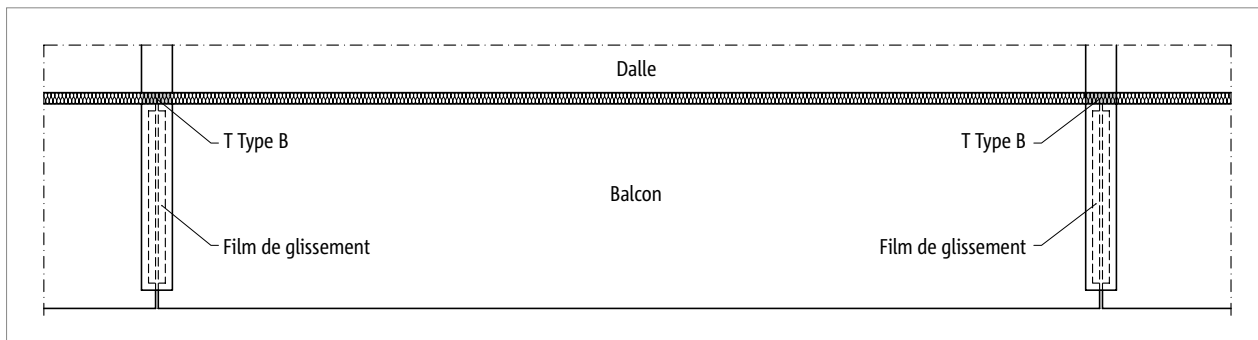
Schöck Isokorb® T Type B : Construction de balcon avec poutrelles en porte-à-faux (balcon préfabriqué)
